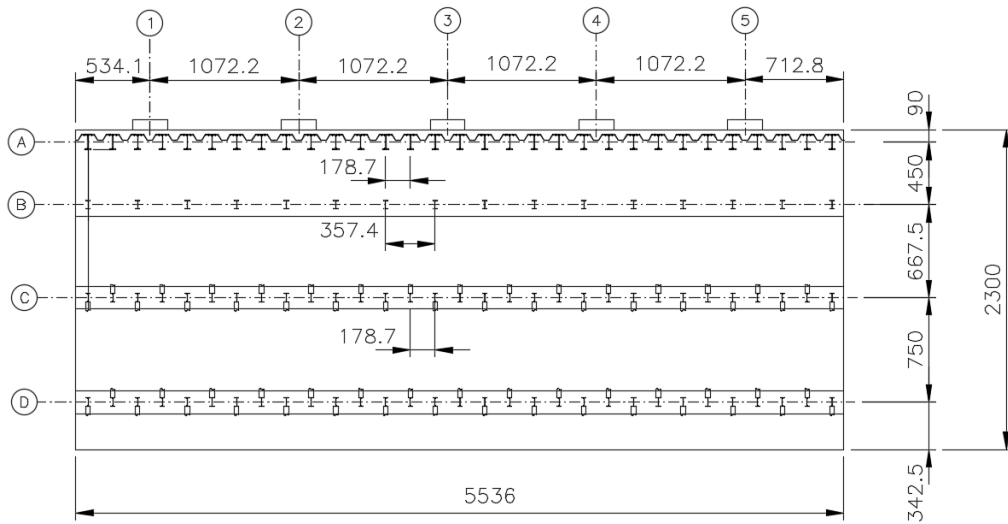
Vista inferior da estrutura. Dimensões em centímetro, níveis em metro.
